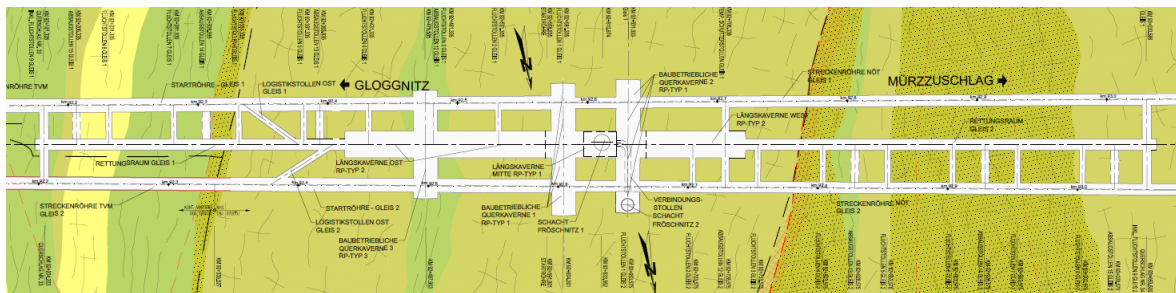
Grundriss der Nothaltestelle. (ÖBB Infra-1, 2016).
